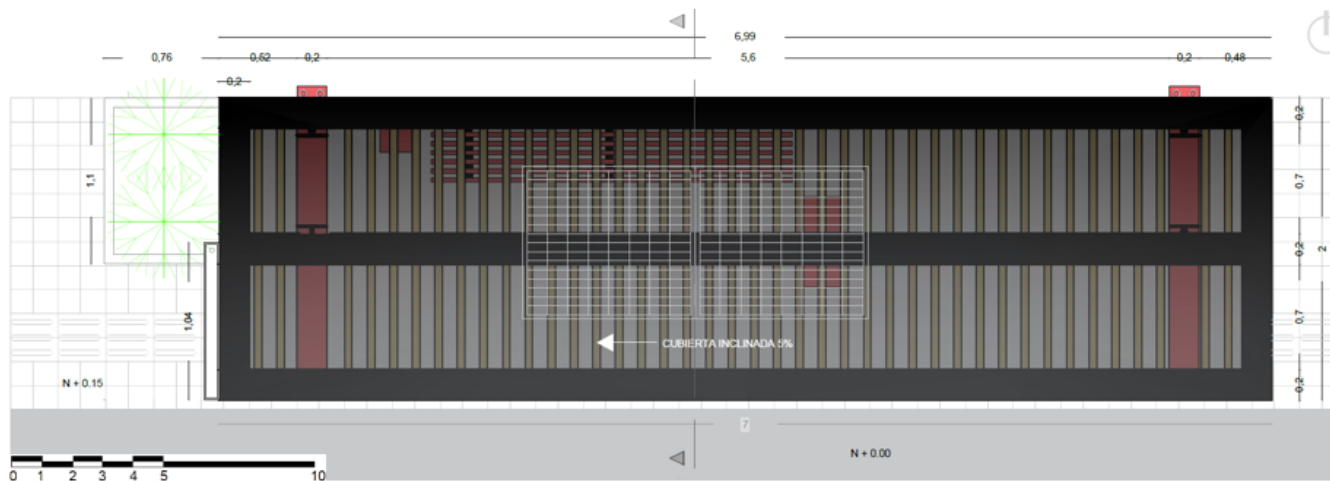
Planta de cubierta del mobiliario de las paradas más utilizadas, escala 1:50. Elaboración propia.
